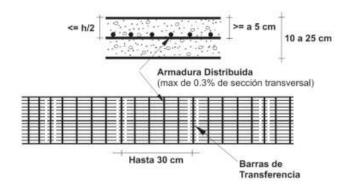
PCH con Refuerzo de Acero Fuente: Acurio, 2012
